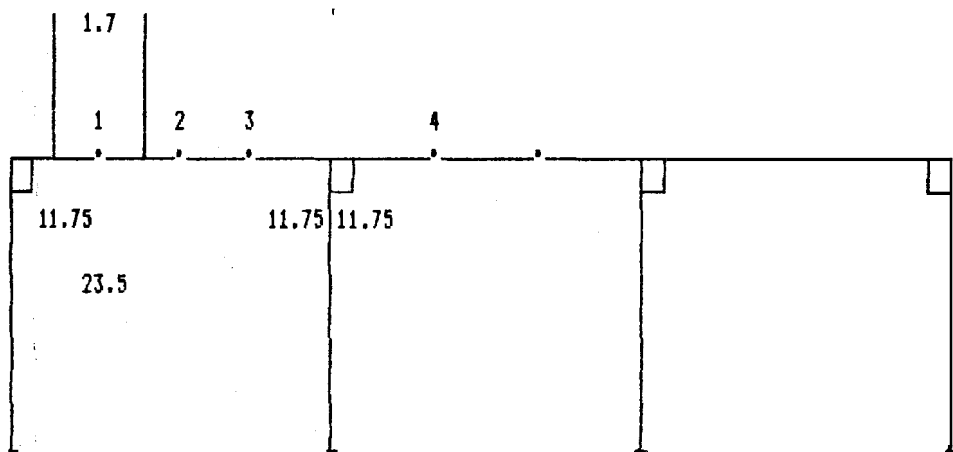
Portico Plano ortogonal a nudos rígidos
